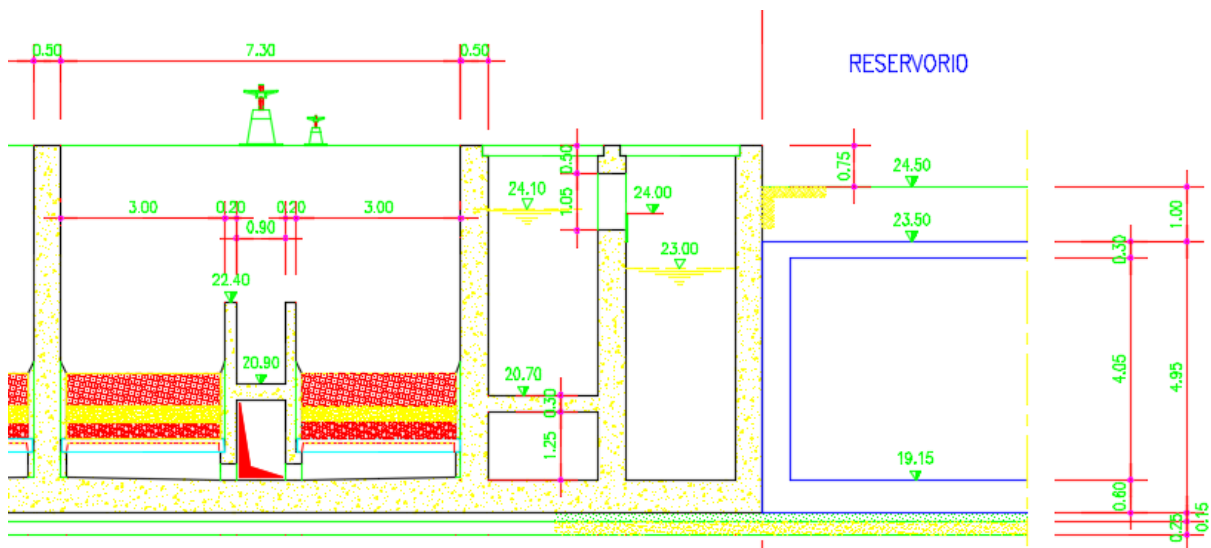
Vista en corte longitudinal a la salida de los filtros.
